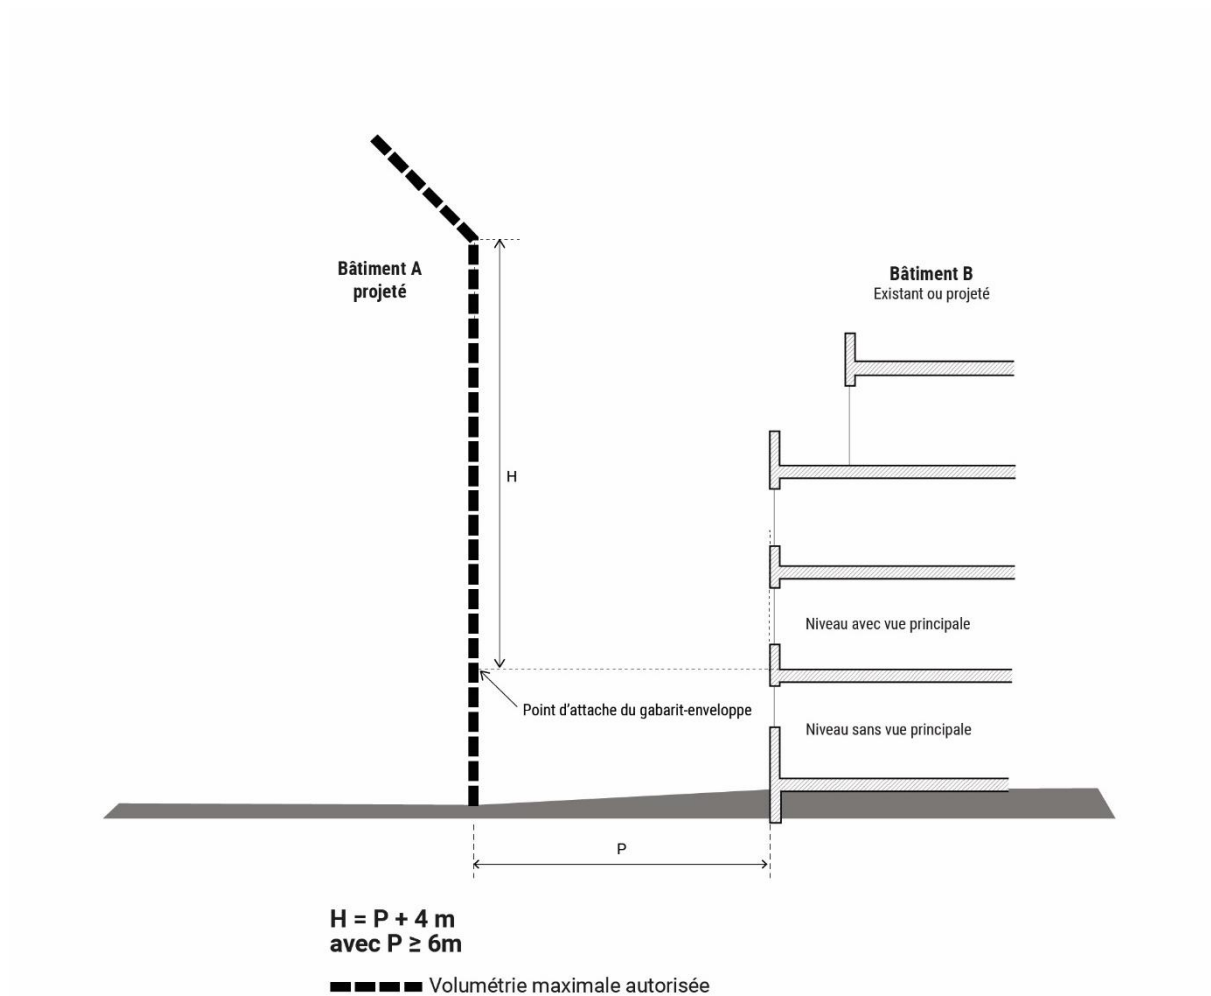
(Partie 3, UG.3.2.6, 1°)Gabarit-enveloppe* des constructions en vis-à-vis sur un même terrain
